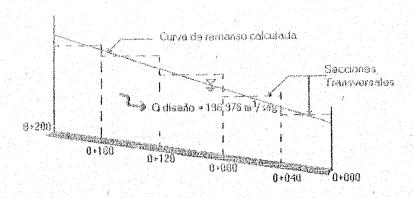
Corte longitudical del arroyo Atolinga, para el cálculo del perfil hidráulico.
